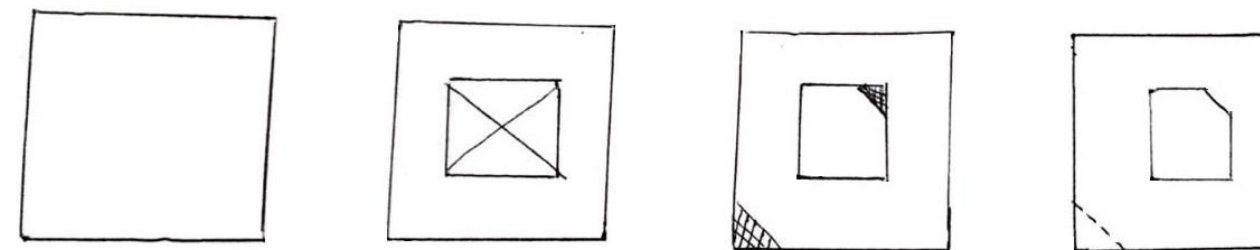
Ilustración del proceso de diseño en planta. Basado en la planta arquitectónica del proyecto. Elaborado por autoras.
